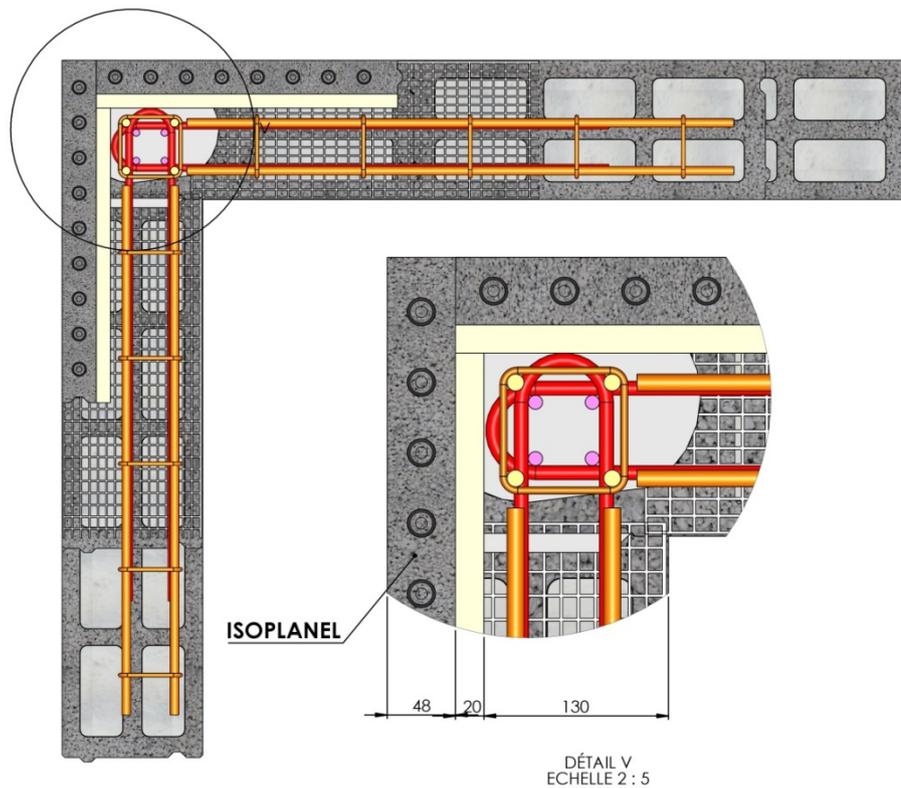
Chaînage horizontal (détail ISOPLANEL)
